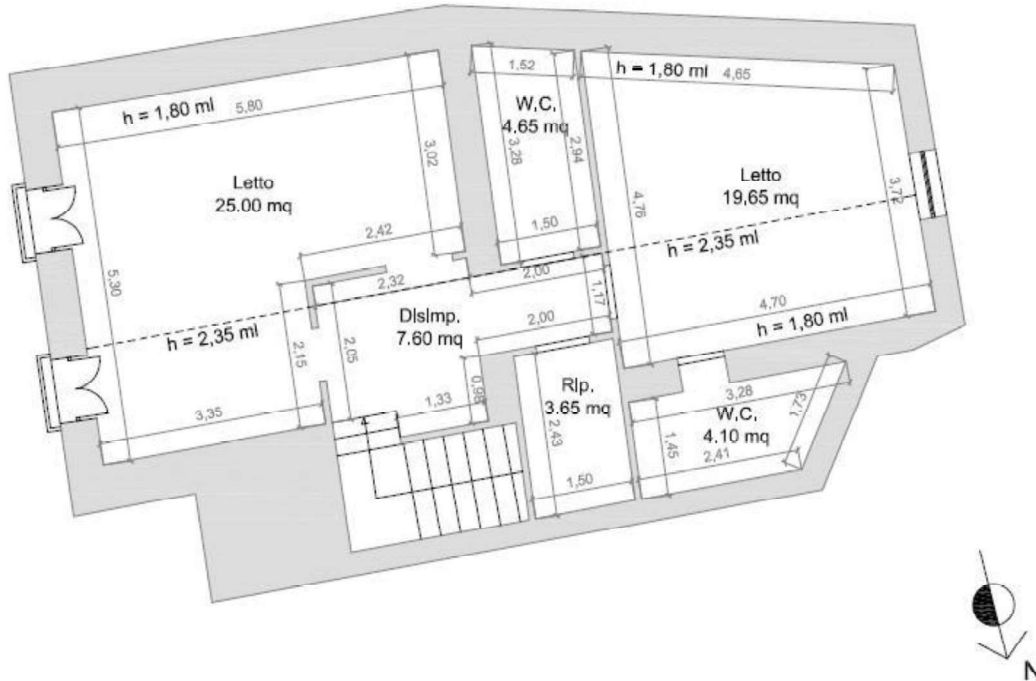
Planimetria Stato di Fatto Immobile, Piano Sottotetto, Foglio 35, p.lla 817, Sub //.
